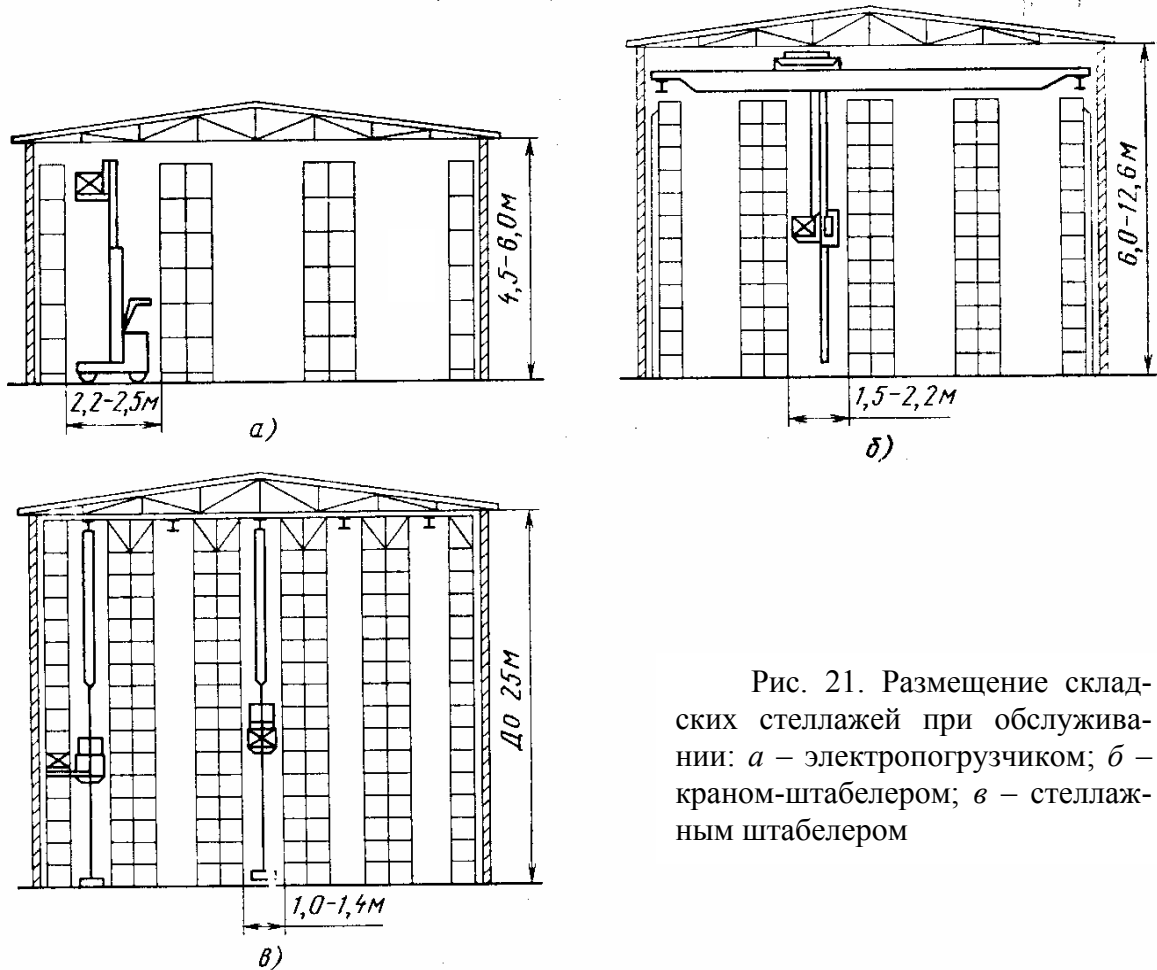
Размещение складских стеллажей при обслуживании: а – электропогрузчиком; б – краном-штабелером; в – стеллажным штабелером
